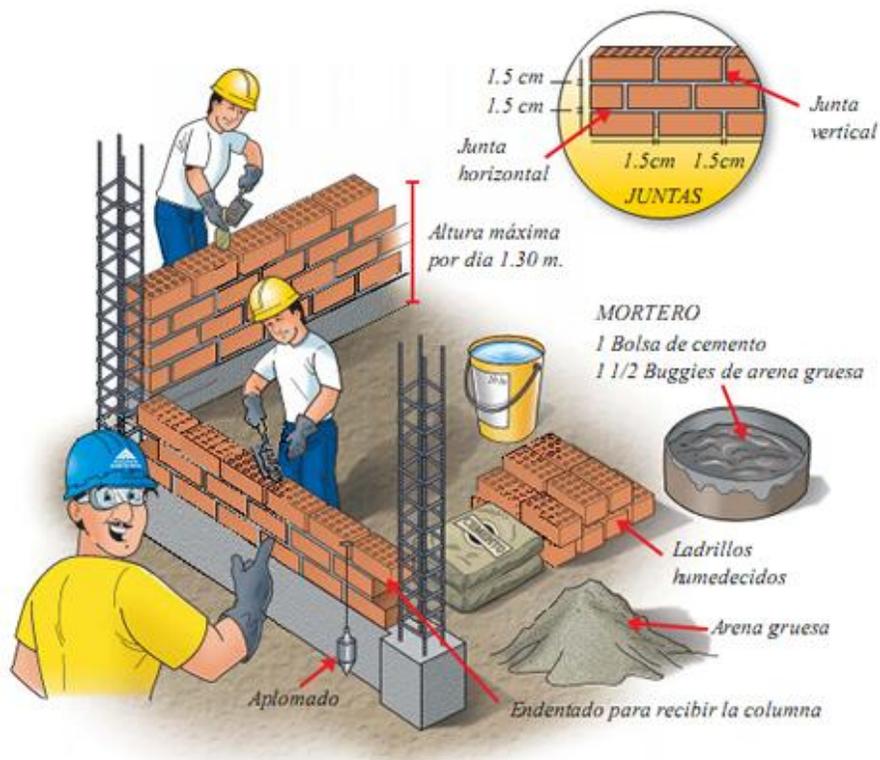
Levantamiento de Muro. Nota: Acerosarequica (2014)
